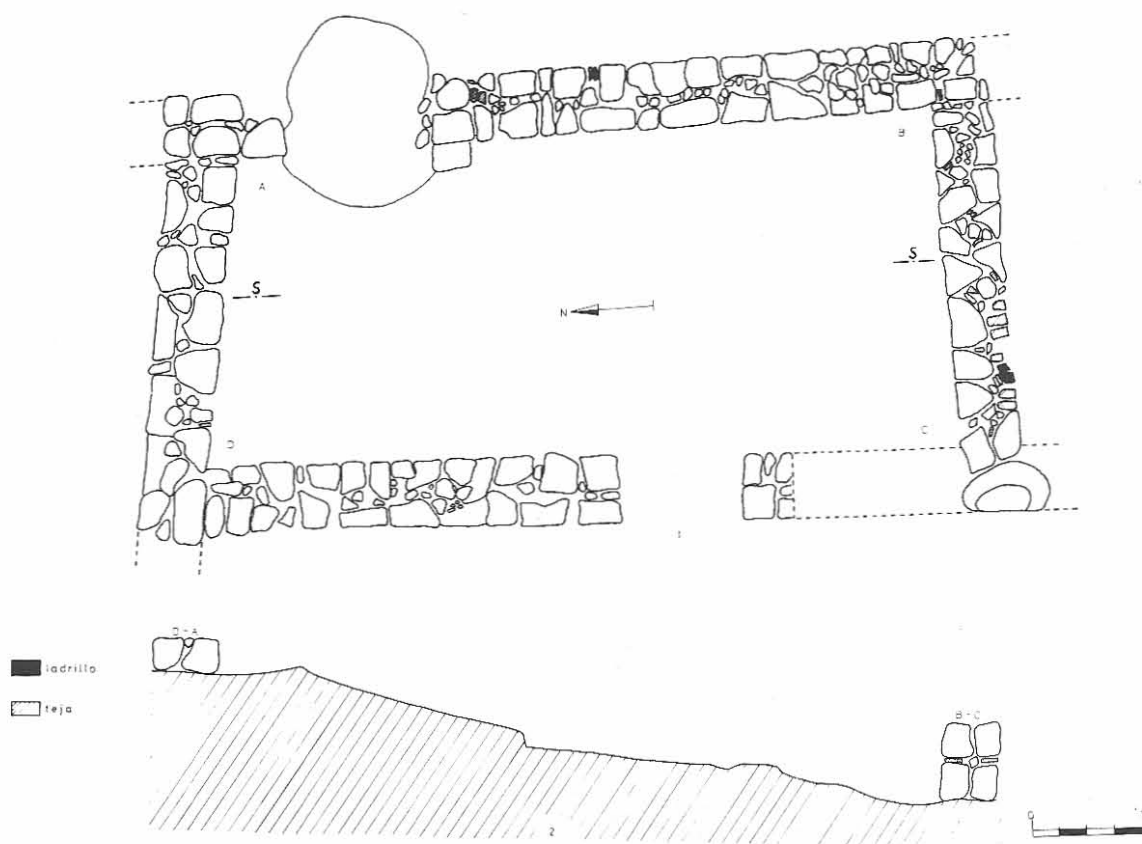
N.º 1. Planta del sector 6. N.º 2. Sección norte-sur del mismo sector.
